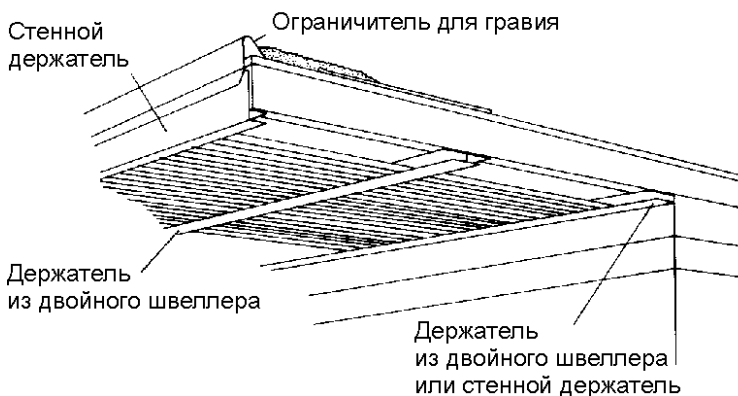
Использование держателя из двойного швеллера и обшивка свеса крыши двумя полосами рулонного софита (Reynolds Metals Products)
